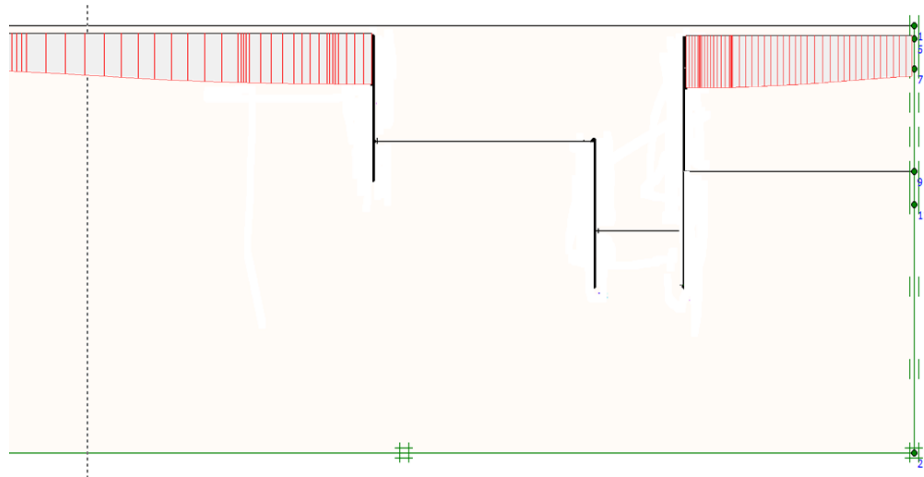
Section Type A – COMB_FOND – Tassements autour de l'excavation
